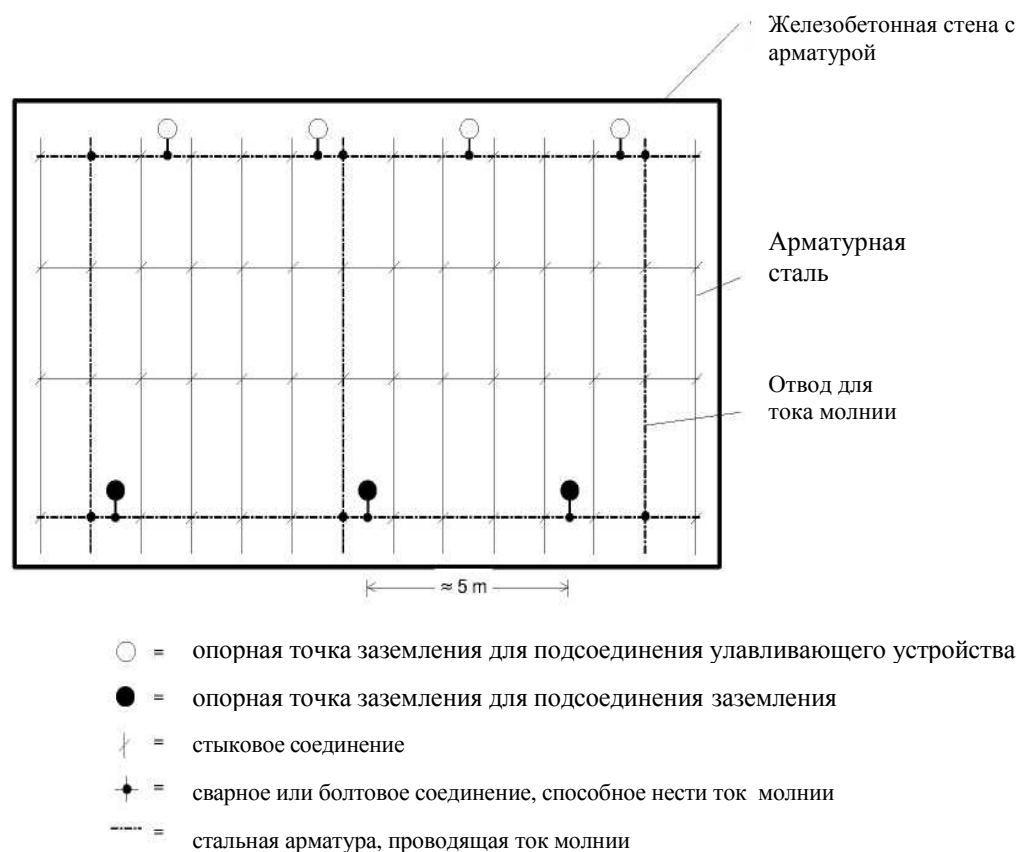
Использование арматуры бетона железобетонной стены как отводчик тока молнии
